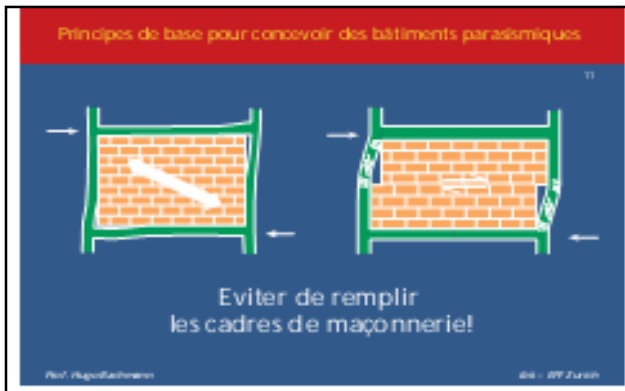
Risque d'apparition des bielles de compression sur la structure.
